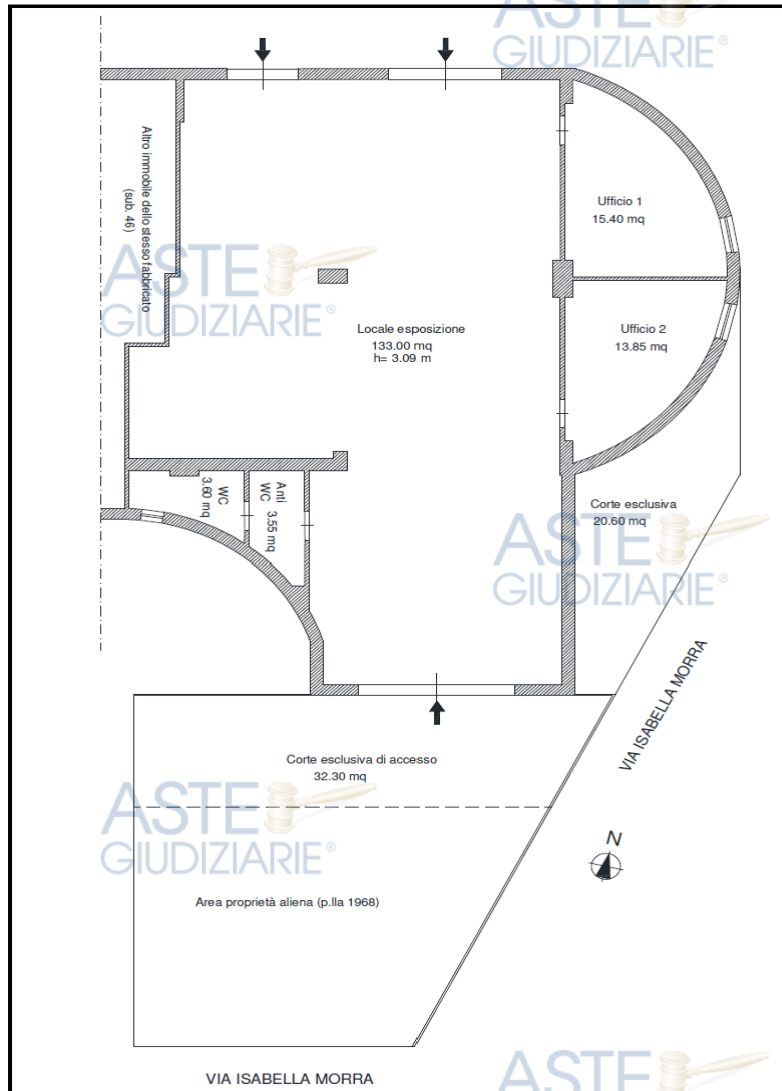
Pianta del locale commerciale in piano terra Lotto 1 (Fig. 74, p.lla 1852, sub. 13)
